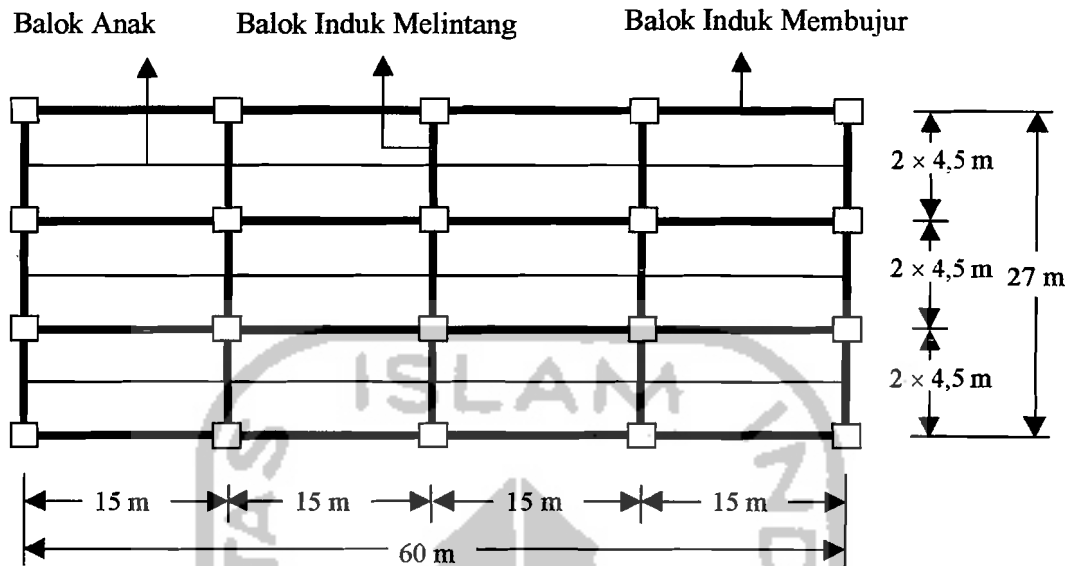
Denah Penempatan Balok Anak Tipe B
